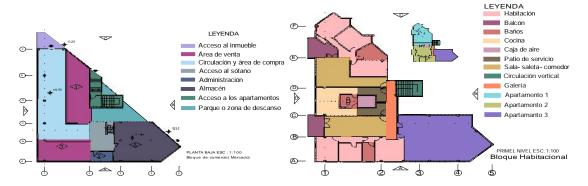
Representación del uso de los locales en planta baja y primer nivel
